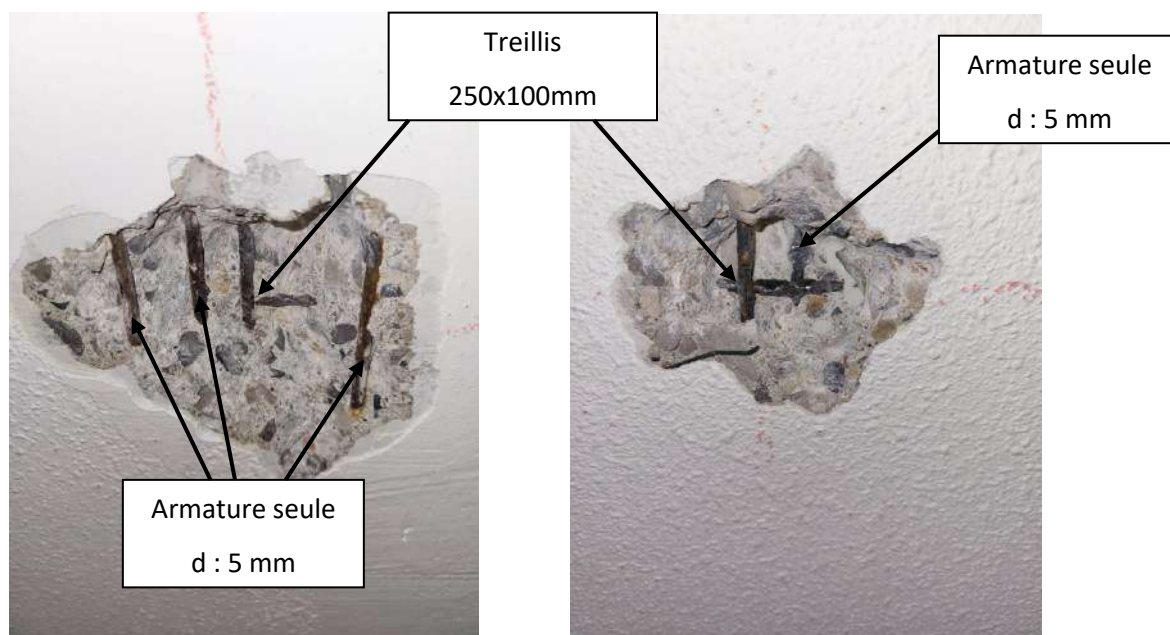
Photo du sondage SH04 (à gauche), coupe de structure SH04 (à droite)
